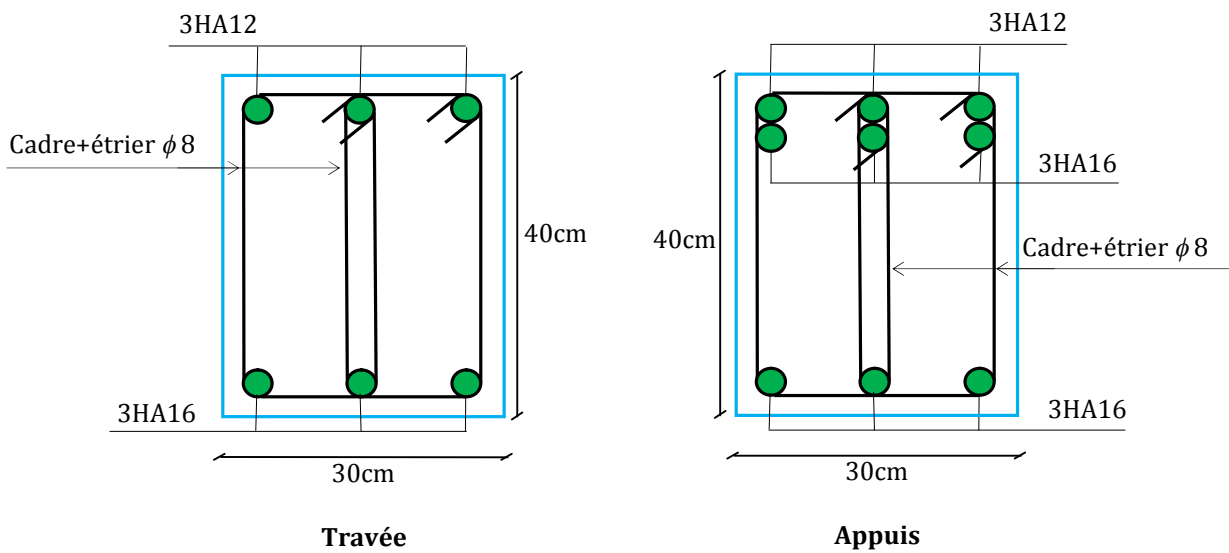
Schéma de ferrailage des poutres principales de 1^{er}, 2^{eme}, 3^{eme} et 4^{eme} étages.
